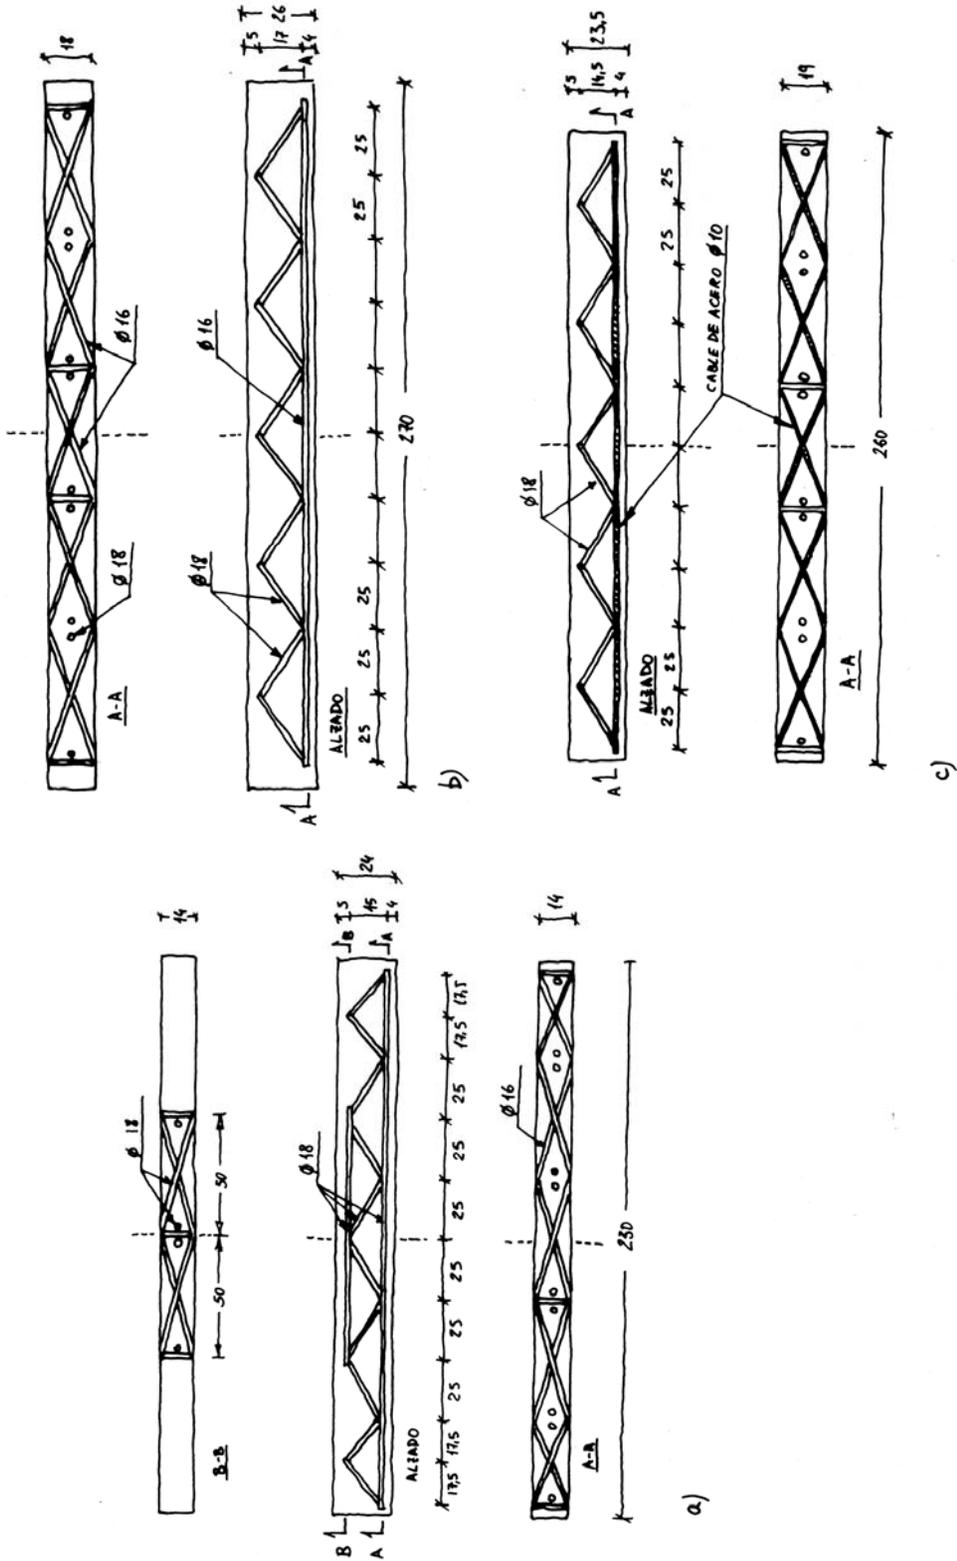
Refuerzo de vigas con armaduras internas (Cigni, 1981).
